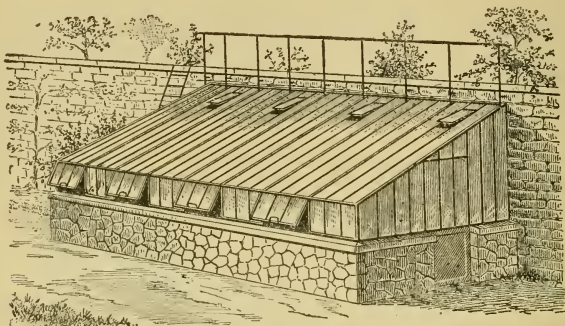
Serre adossée, en fer; comble et pied droits; panneaux d'aérage.
